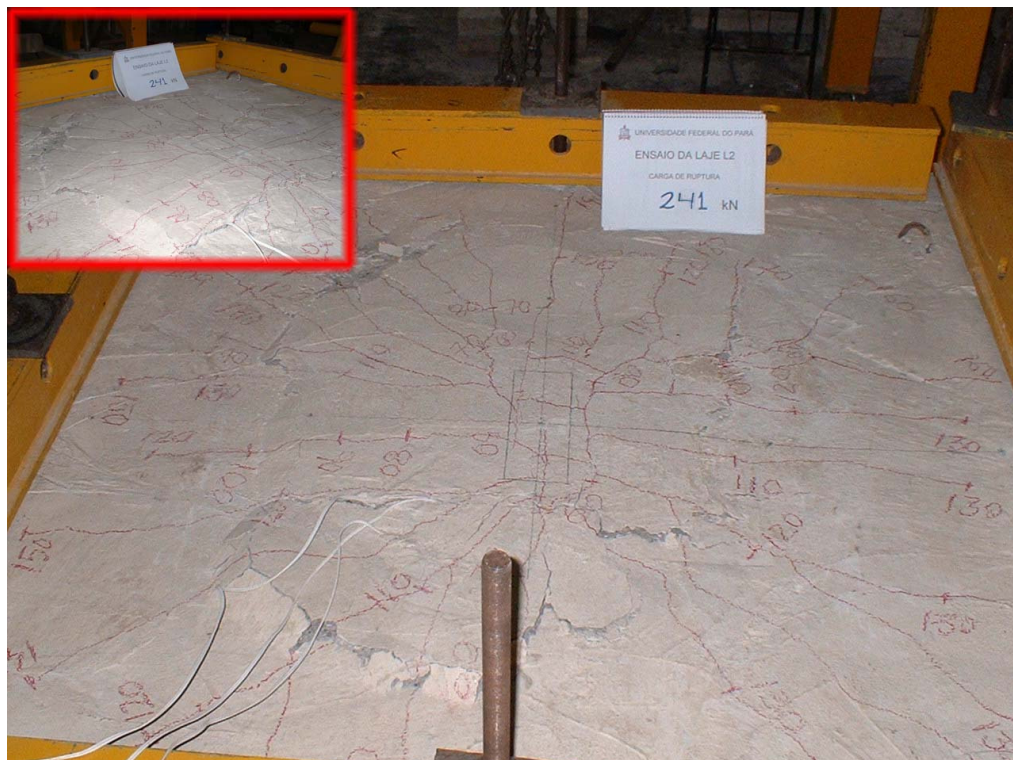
Fissuras desenvolvidas na face superior da laje L2
